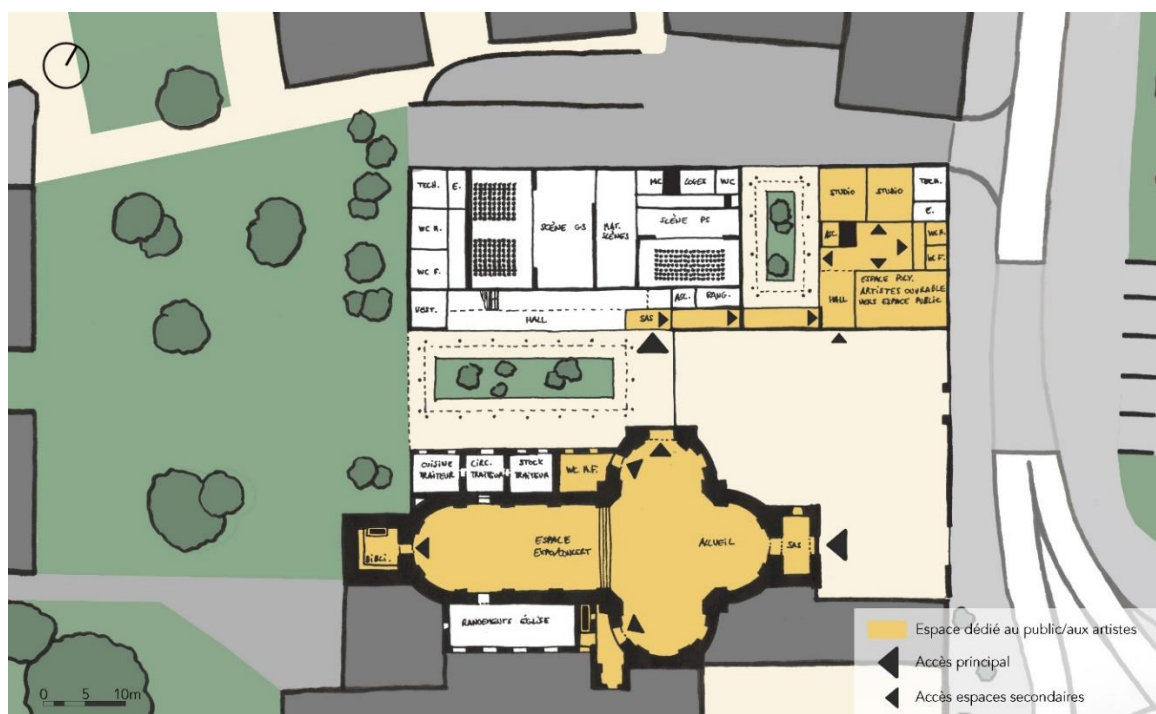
Distribution des accès possibles durant le cheminement d'un étudiant du Conservatoire (fond de plan WalOnMap, 2016)
